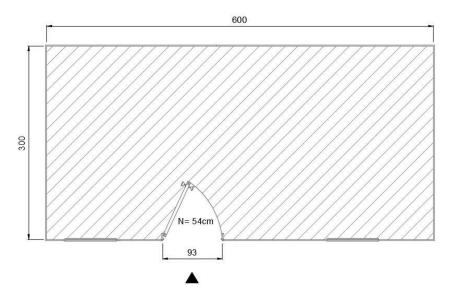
Plano acotado de la vivienda tipo de TECHO, Fuente: Manual para la construcción - TECHO
